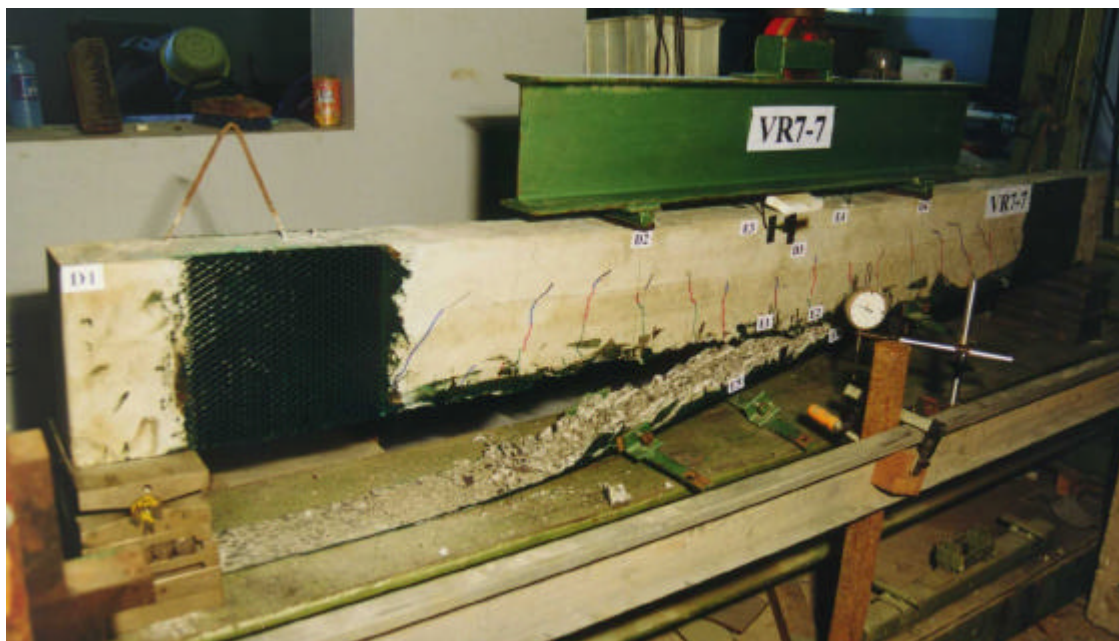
Ruptura por descolamento na viga reforçada com sete camadas
